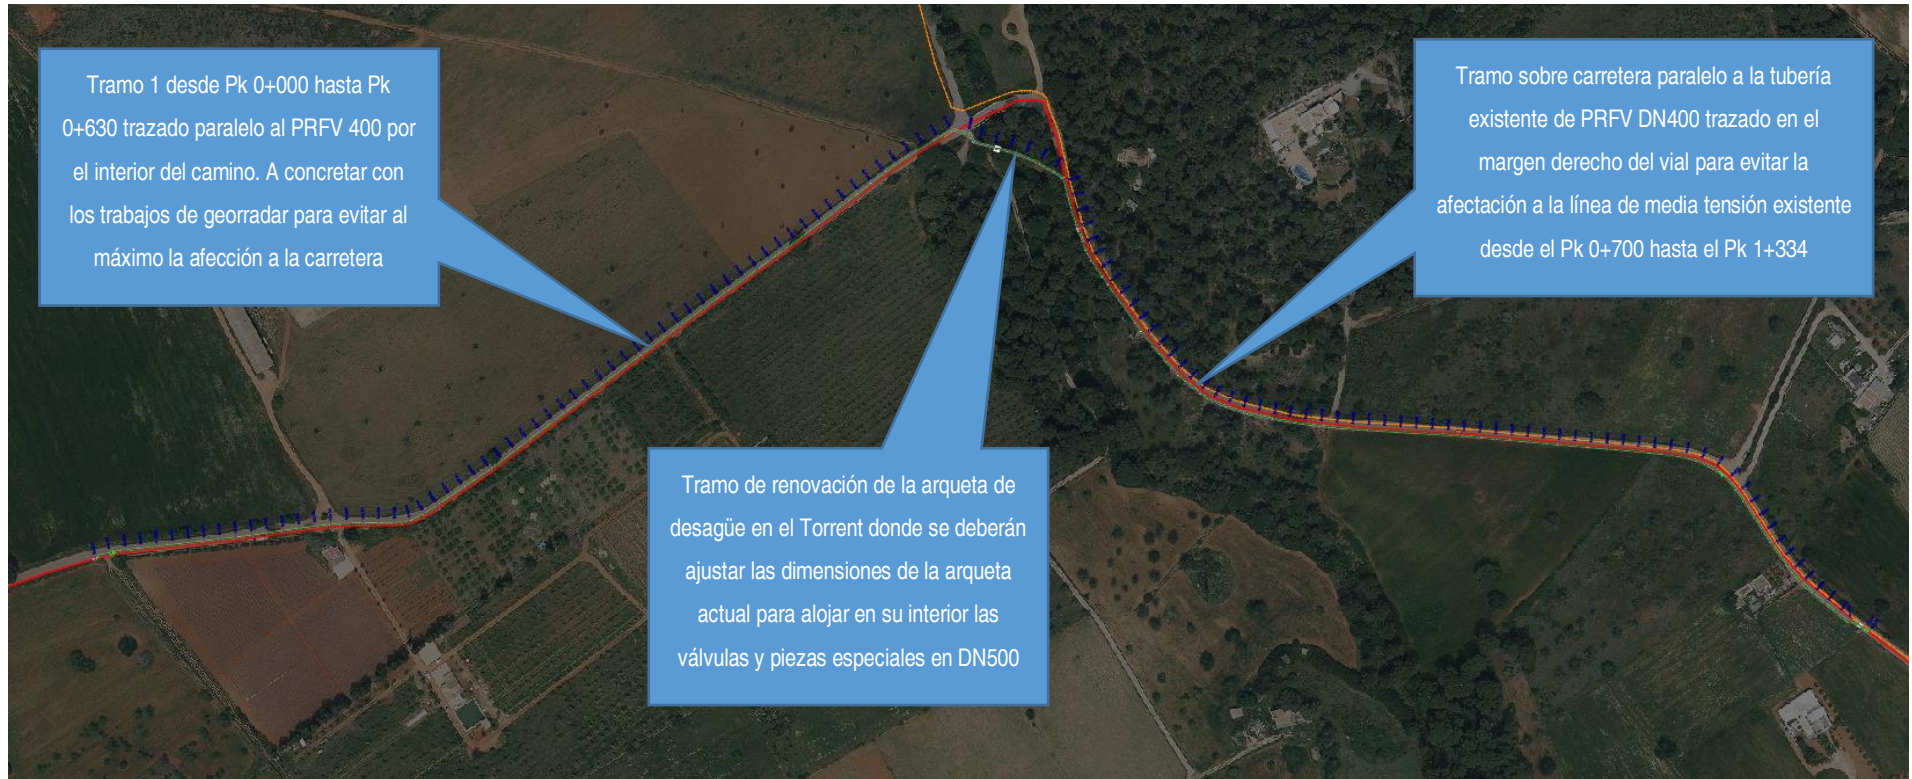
Planta general del trazado propuesto para la renovación del tramo de PRFV 400 existente en la actualidad. Fuente: Elaboración Propia
